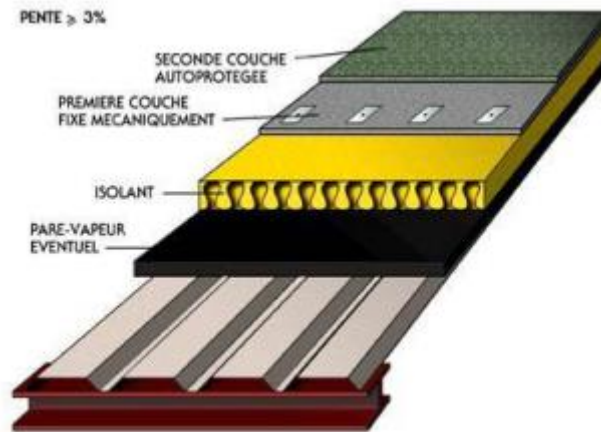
Exemple de couverture en acier avec isolation et étanchéité.
